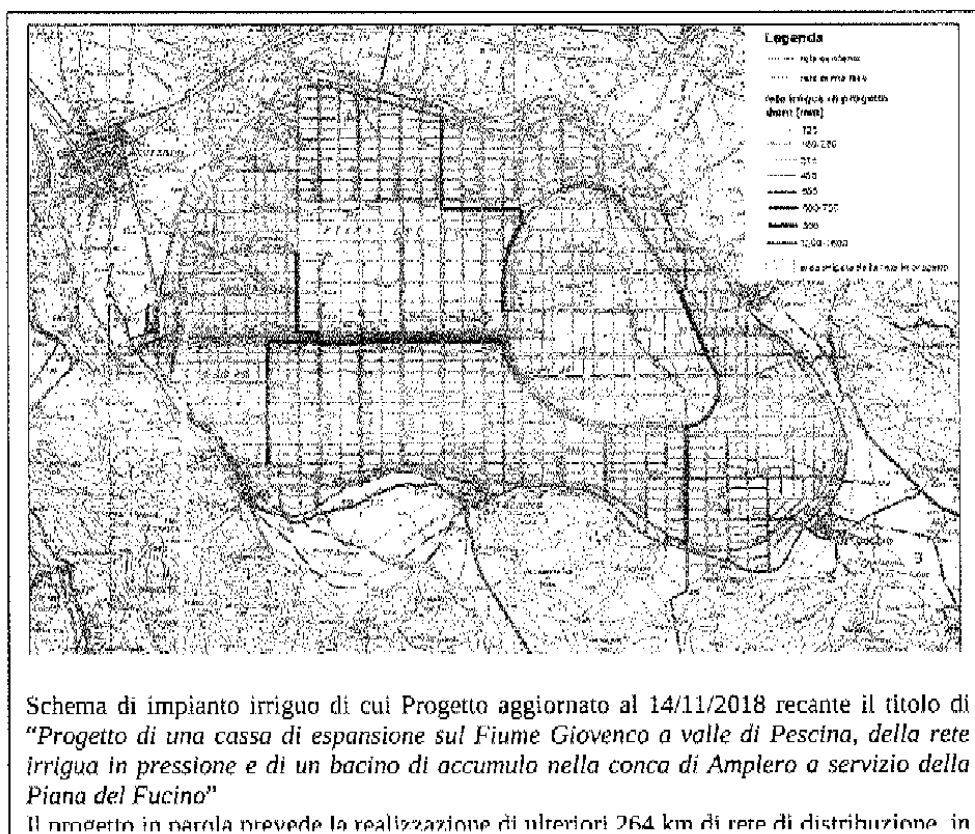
Cassa di espansione sul f. Giovenco – estratto planimetrico.
